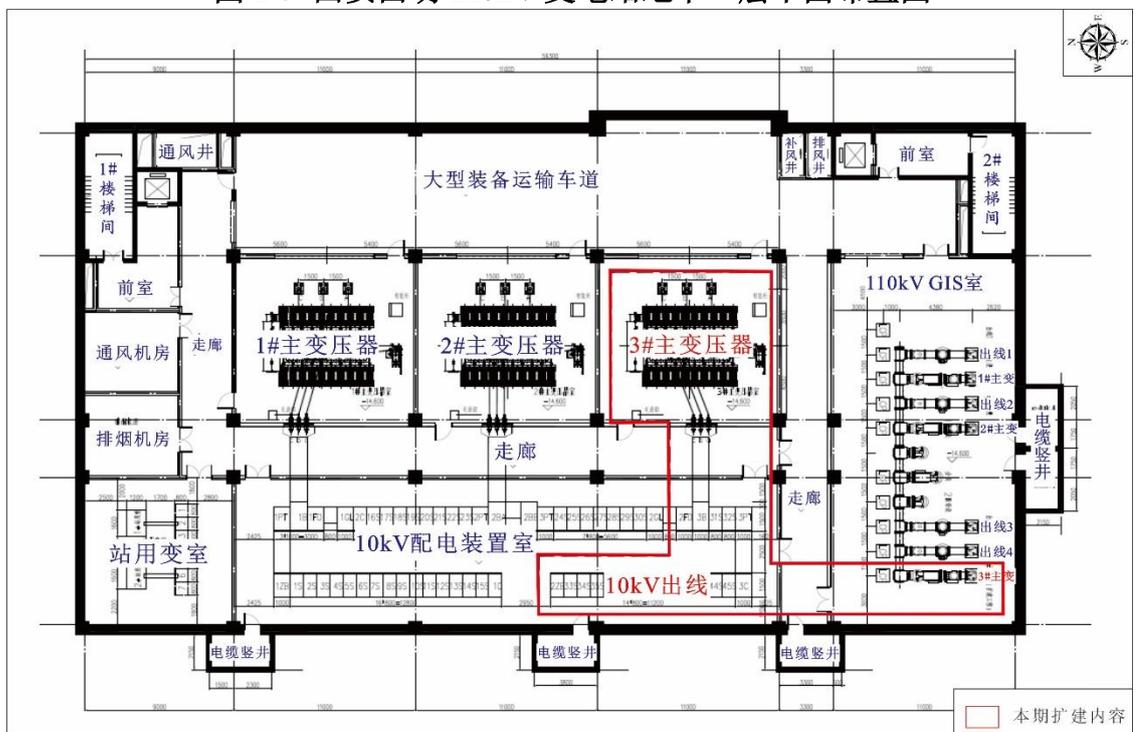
西安昌明 110kV 变电站地下三层平面布置图
